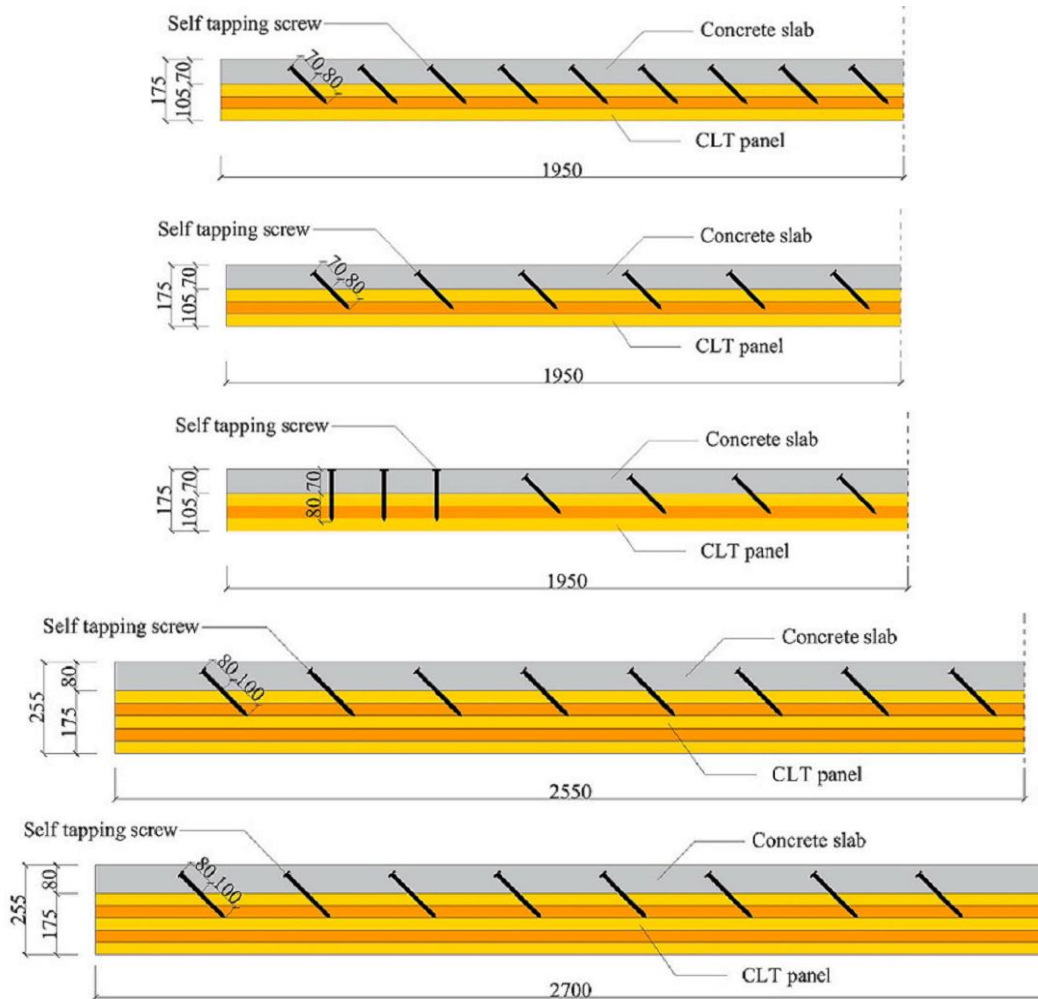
Les poutres mixtes Bois CLT-béton avec différent configuration des connexions conçu et testé par Bao et al. [30]
